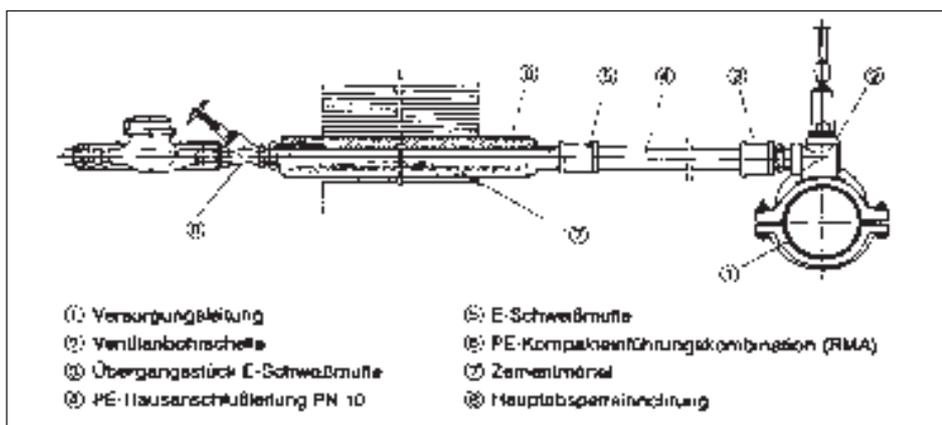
Mantellose, auszugssichere Mauerdurchführung
